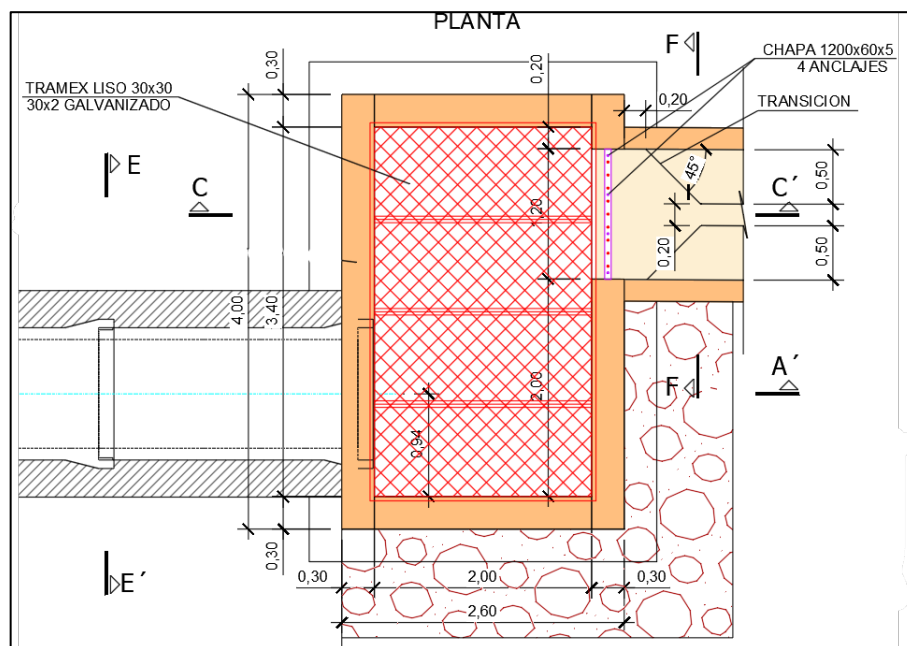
Vista en planta de la estructura disipadora. A la izquierda, la conducción mediante tubos de hormigón. A la derecha, conducción de la cuneta hormigonada.
